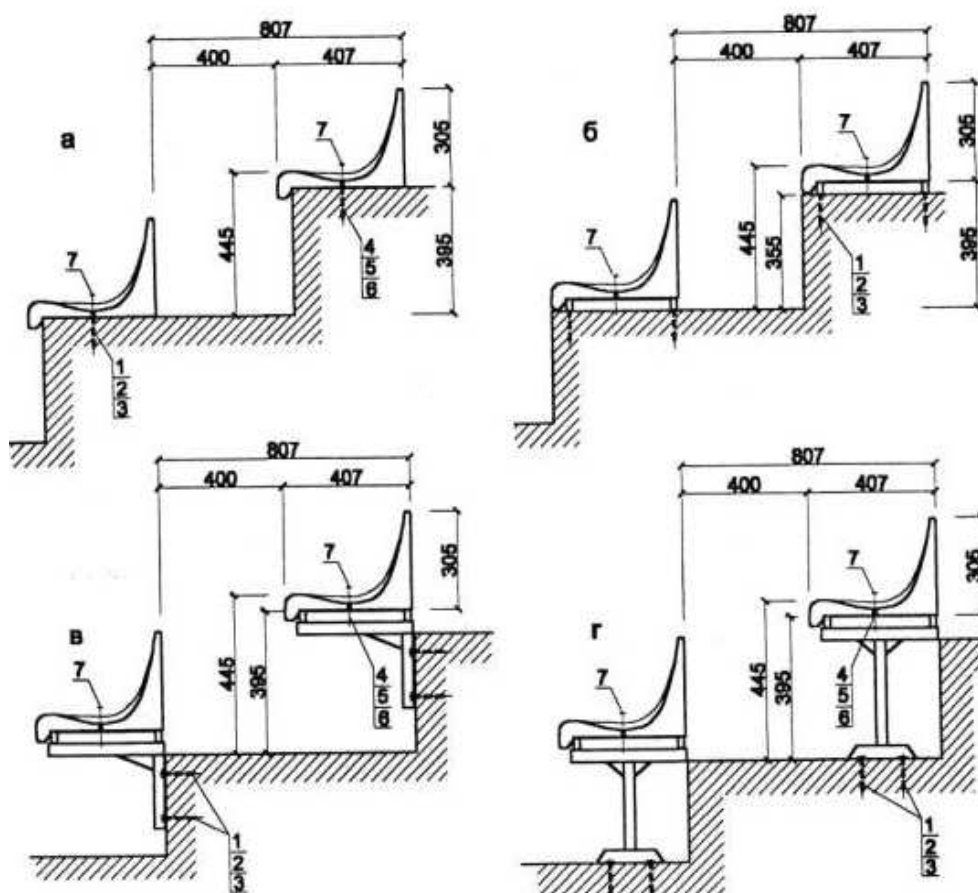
Крепление пластиковых сидений на капитальных трибунах [СП 31-115-2006]: а) непосредственно на бетонную поверхность; б) к металлоконструкциям на бетонной поверхности; в) к консольным металлоконструкциям; г) на поддерживающие металлоконструкции
